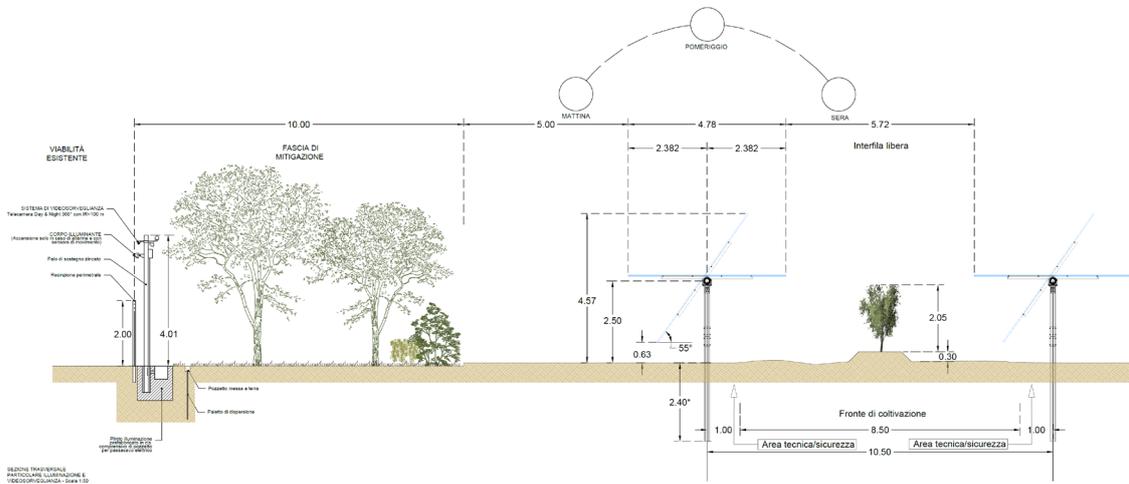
Particolare costruttivo sezione trasversale tipologica impianto con le dimensioni di progetto fuori scala.
